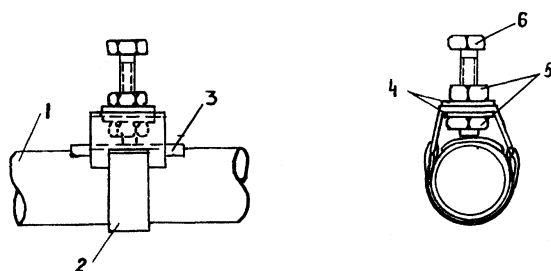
Использование водопроводных труб в качестве заземления абонентских пунктов:
